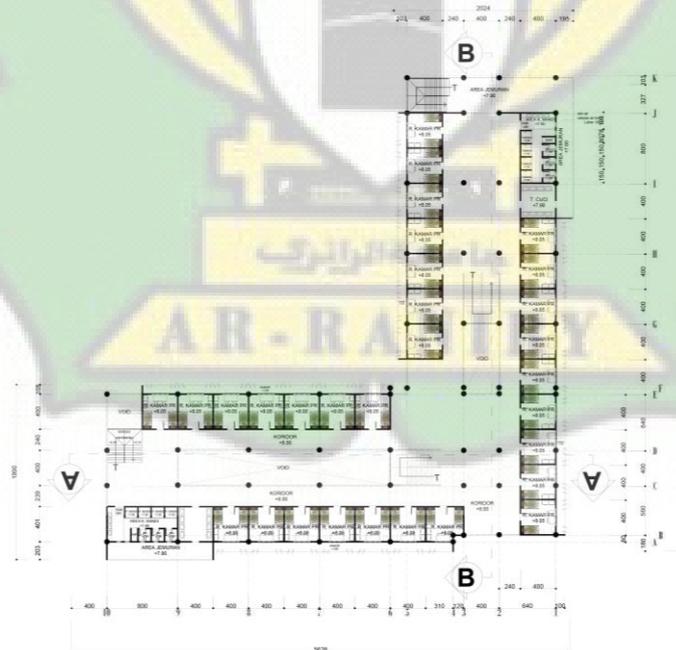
9 Denah Asrama Perempuan Lantai 1
